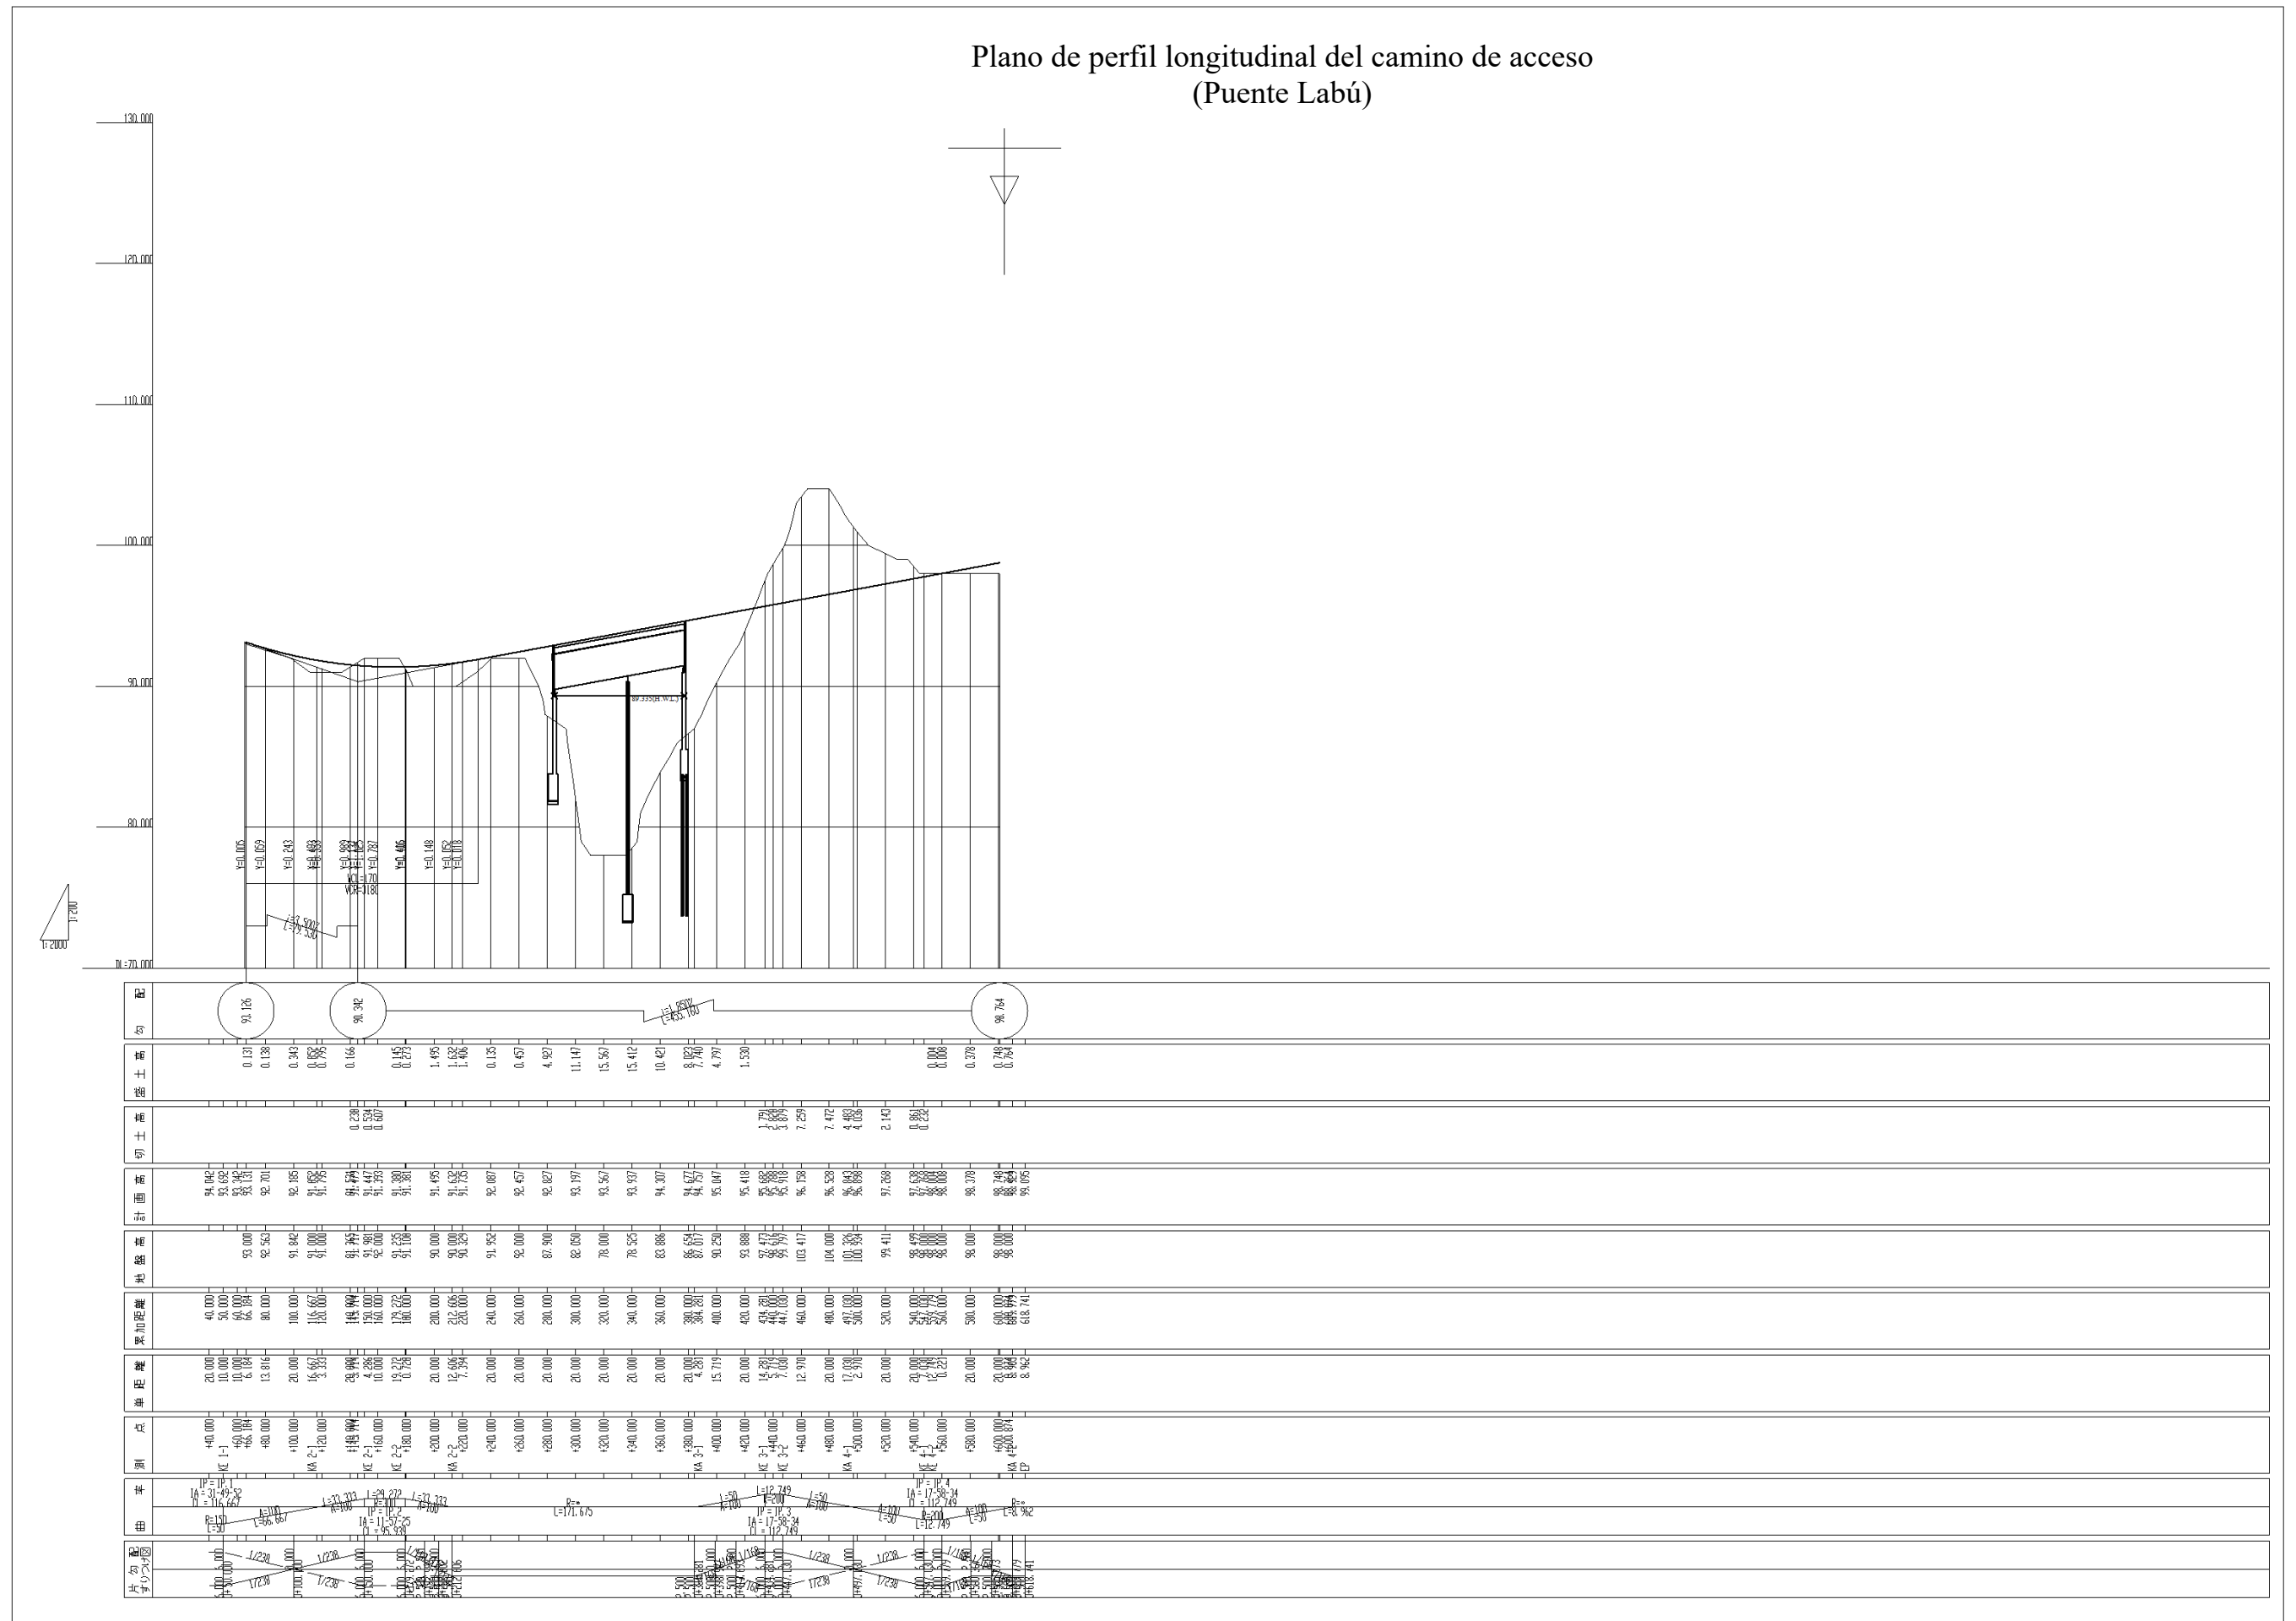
Plano de perfil longitudinal del camino de acceso (Puente Labú)
